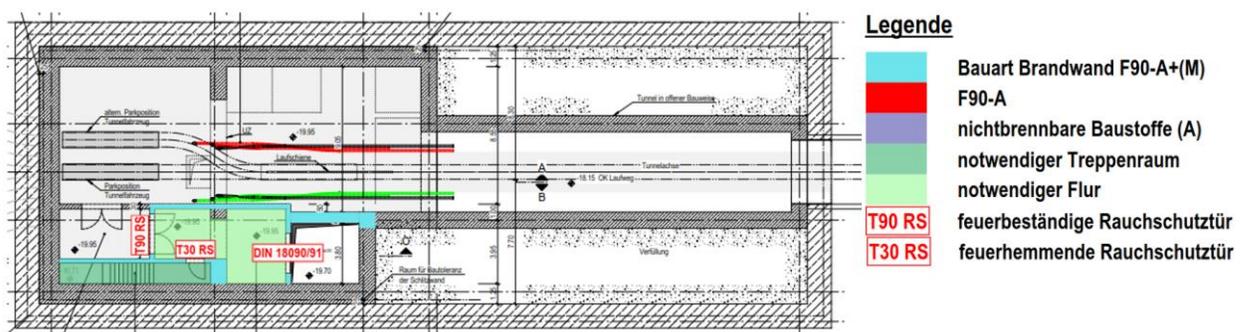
Grundriss: Das fünfte Untergeschoss mit dem Sicherheitstreppenhaus, dem Aufzug und dessen Vorraum ist hellblau eingefasst. Die baurechtlich notwendigen Bereiche sind grün hinterlegt. Die Hochspannungskabel innerhalb des Tunnels sind farblich als rote und grüne Linien dargestellt.
